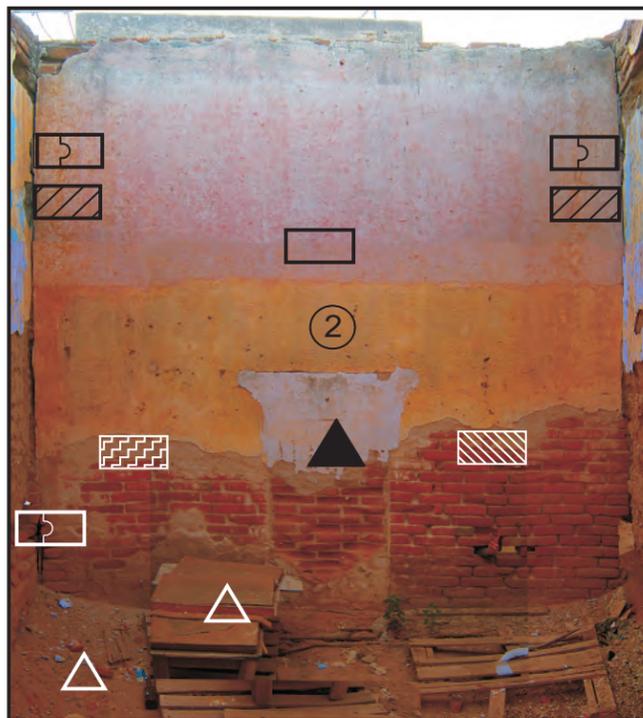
MURO AL PONIENTE DE LA COCINA, ACCESO AL ZAGUÁN CANCELADO.
